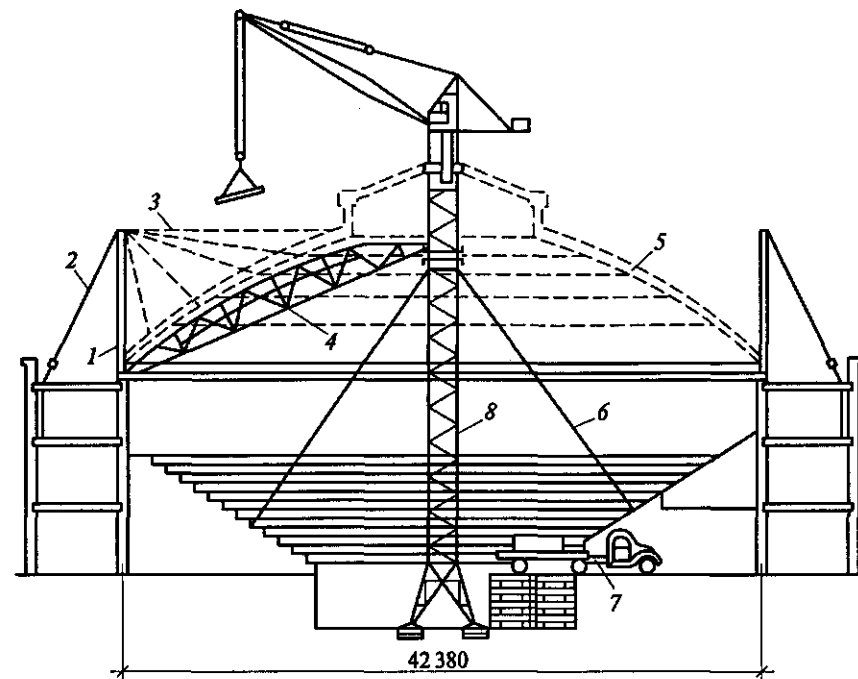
Монтаж купола с помощью передвижной фермы-шаблона: 1 — монтажная стойка; 2 — расчалки-стойки; 3 — тяги-подвески; 4 — ферма-шаблон; 5 — купол; 6 — расчалки; 7 — панелевоз; 8 — кран
